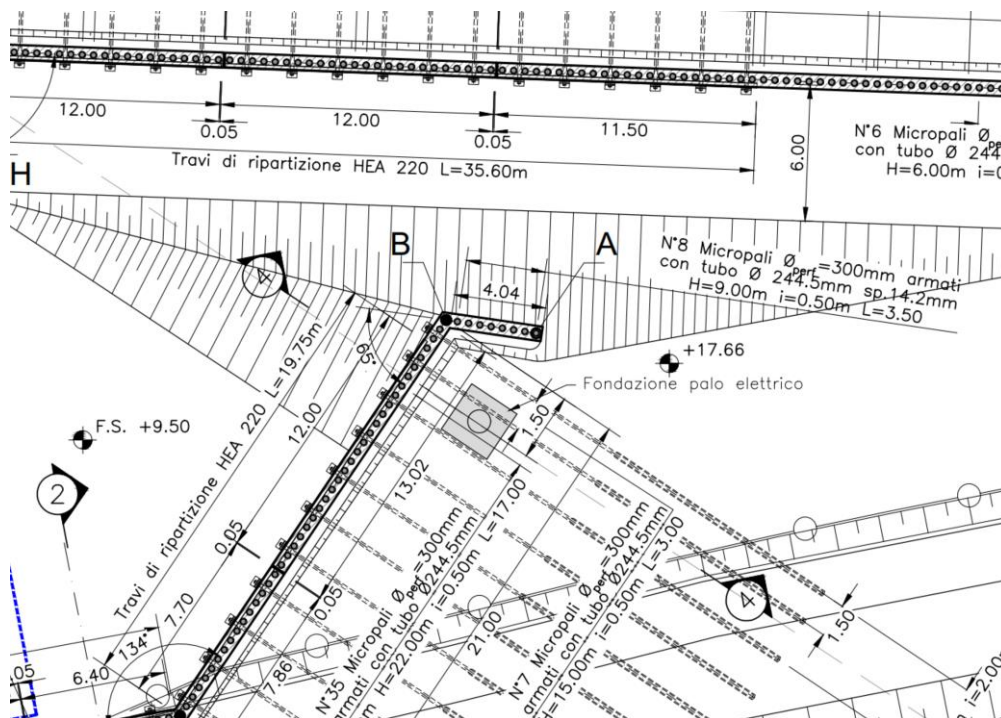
Posizionamento planimetrico della fondazione del palo elettrico in prossimità della rampa di accesso
